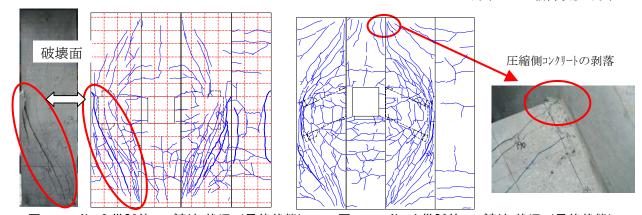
No.3 供試体ひび割れ状況 (最終状態) 図-4
